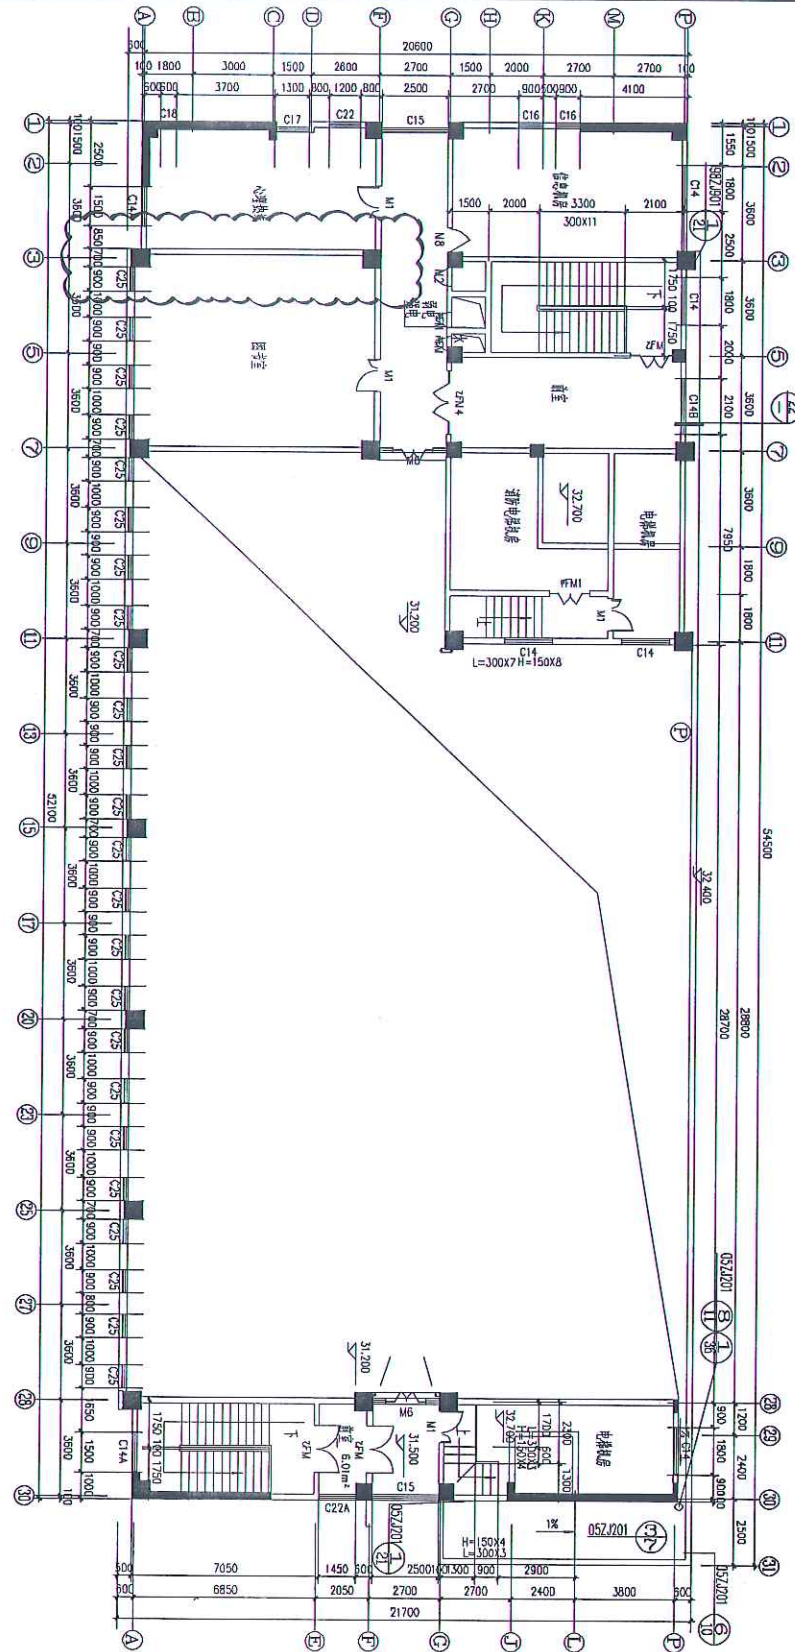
11 层改造设计平面布置图(云线范围为装修改造区域)
